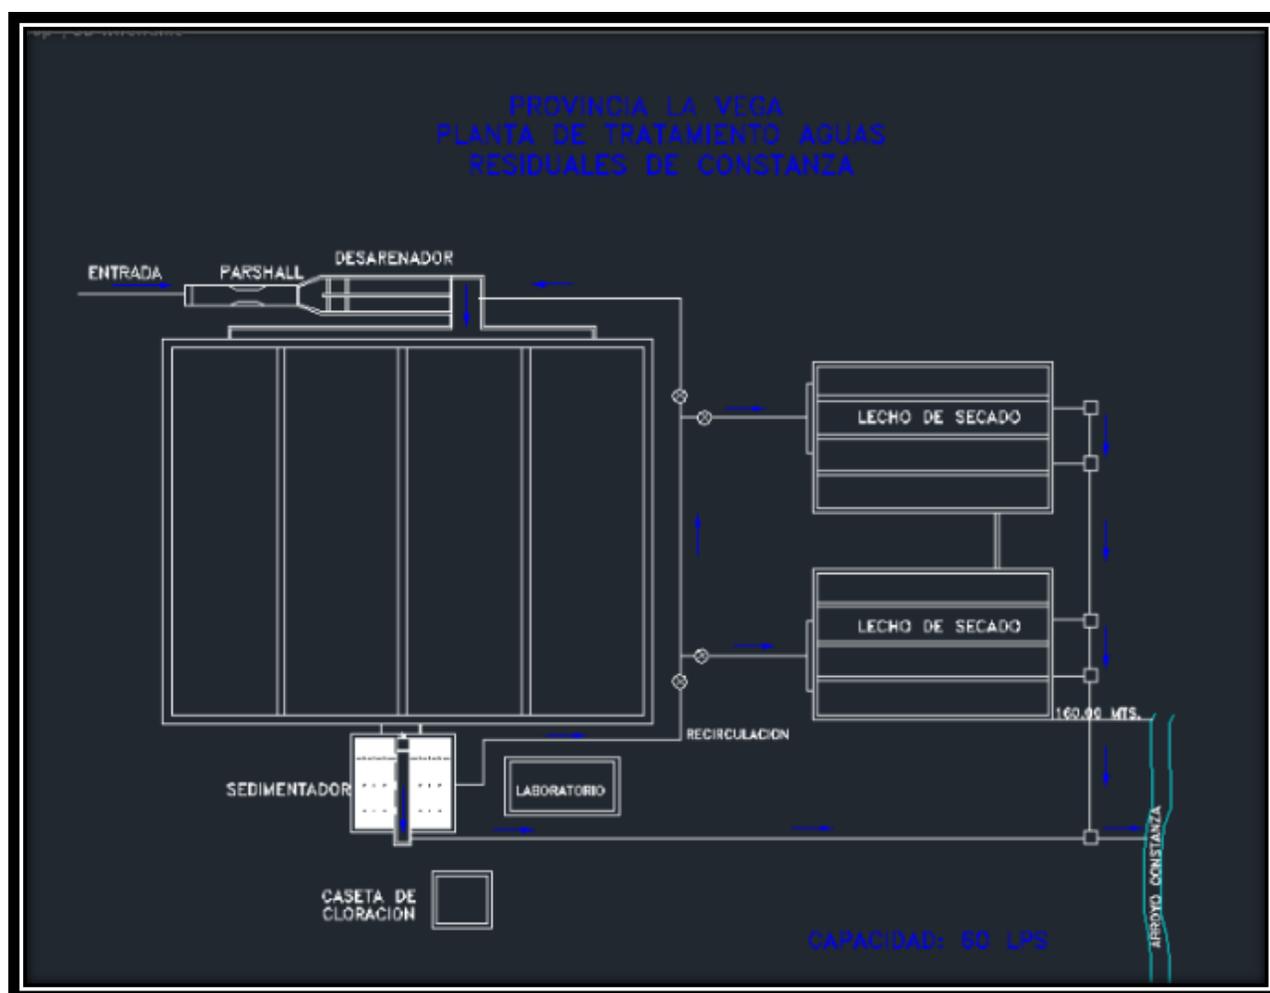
Plano Vista en Planta de la Planta de Tratamiento de Constanza.
